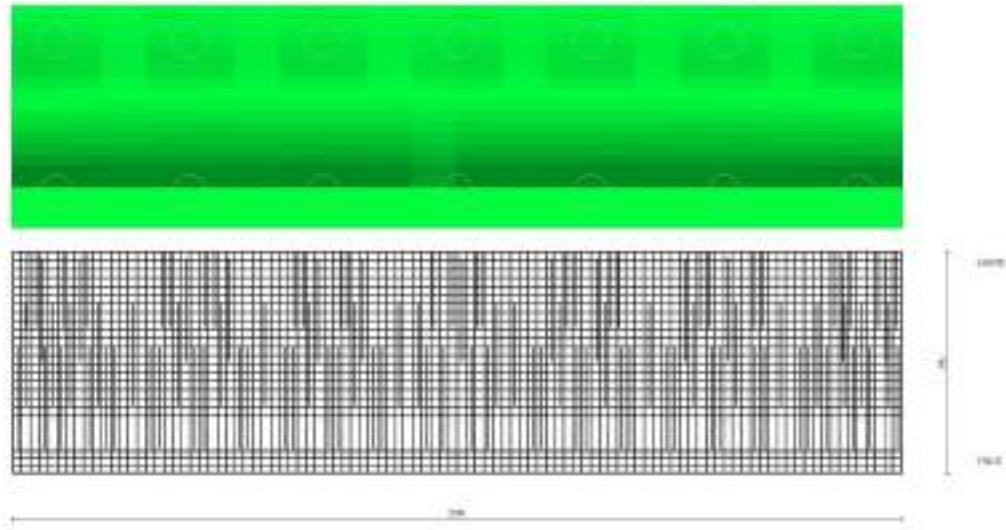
Piastra fondazione dir. Y (Inviluppo)
